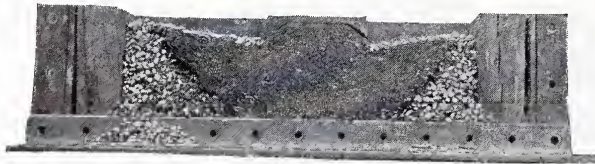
Querschnitt des bewegten Bettungskörpers einer Kiesbettung.
